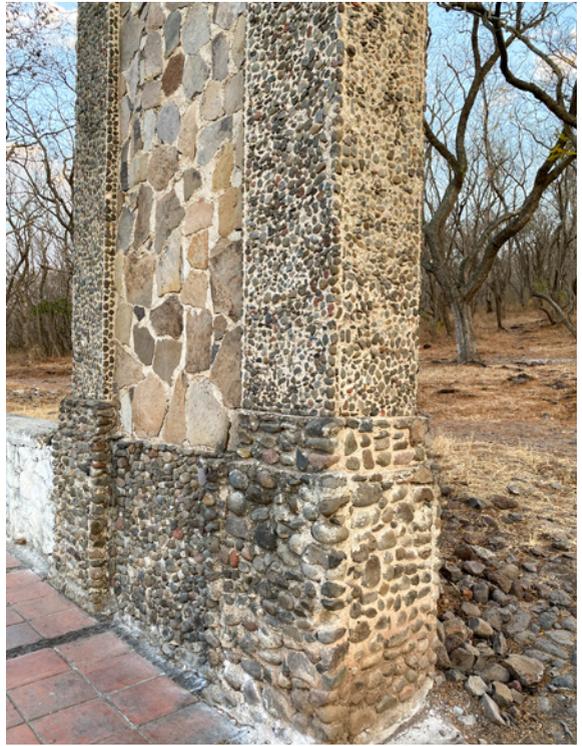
Detalle de trabajo de piedra en la portada del Bosque Juárez. Fuente: fotografía de la autora.
